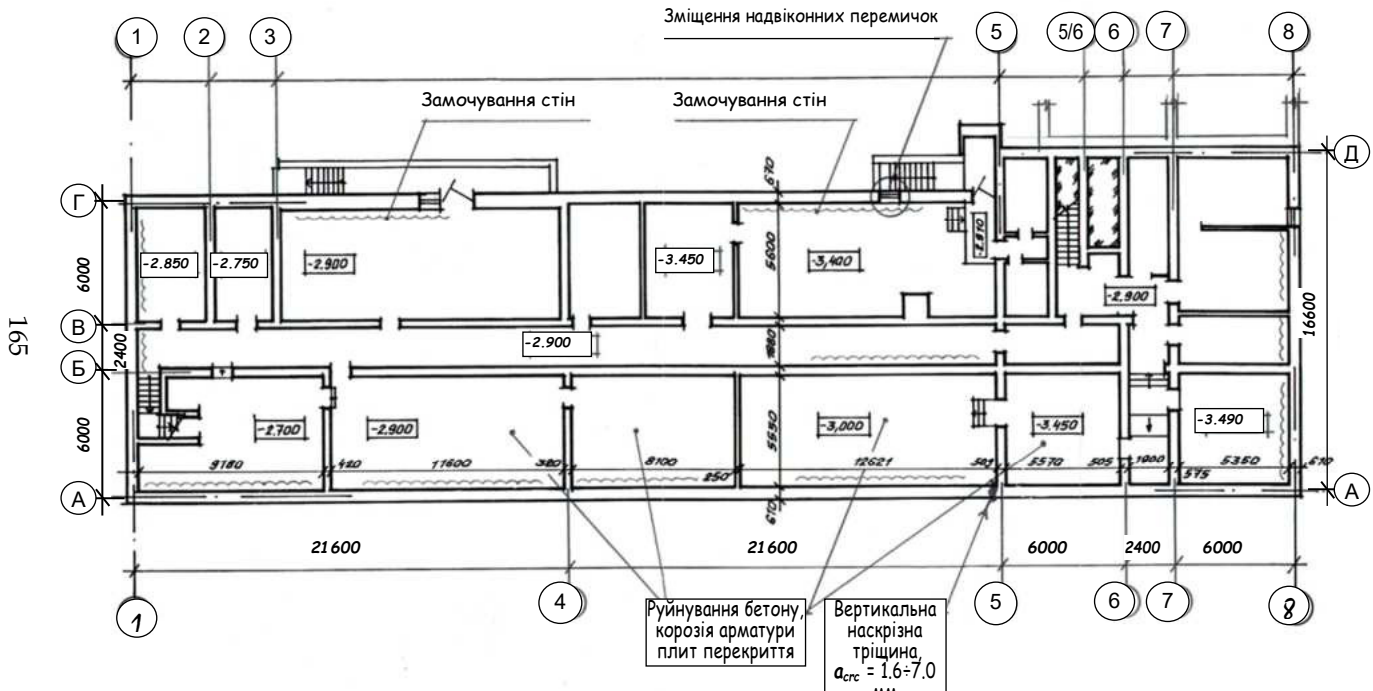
Обмірний план фундаментно-підвальної частини досліджуваної будівлі з картиною дефектів
